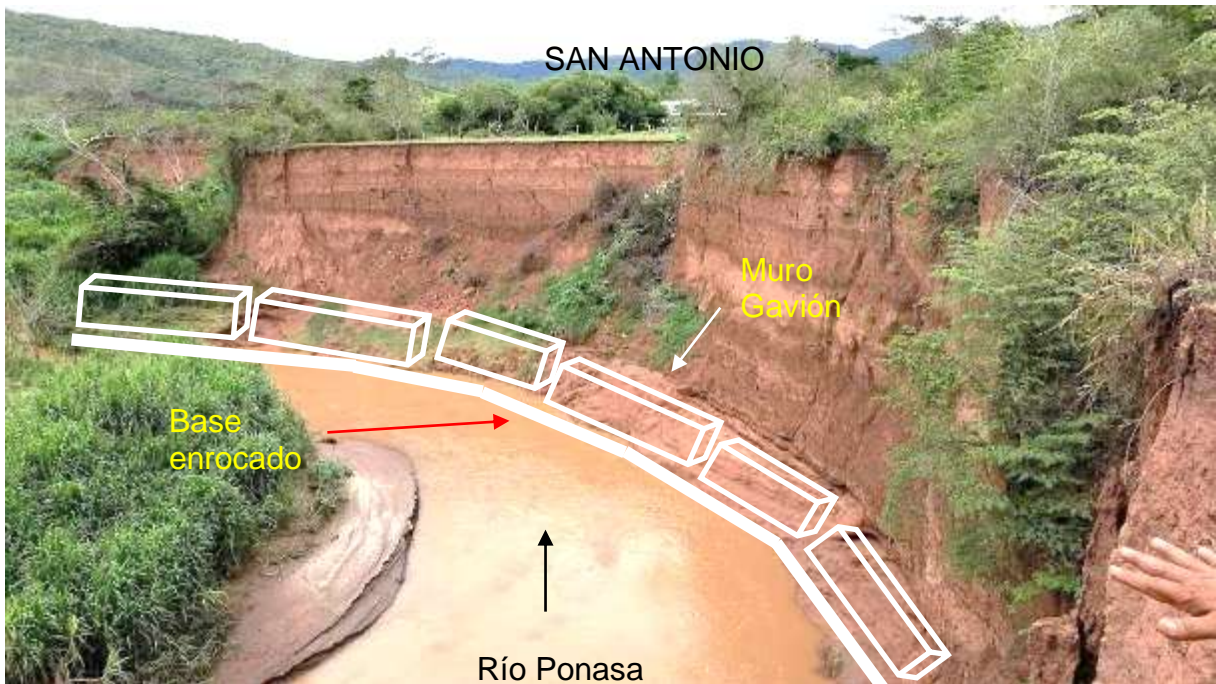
Vista proyectada hacia aguas abajo de ubicación de muro gavión anclado y cimentado sobre enrocado.
